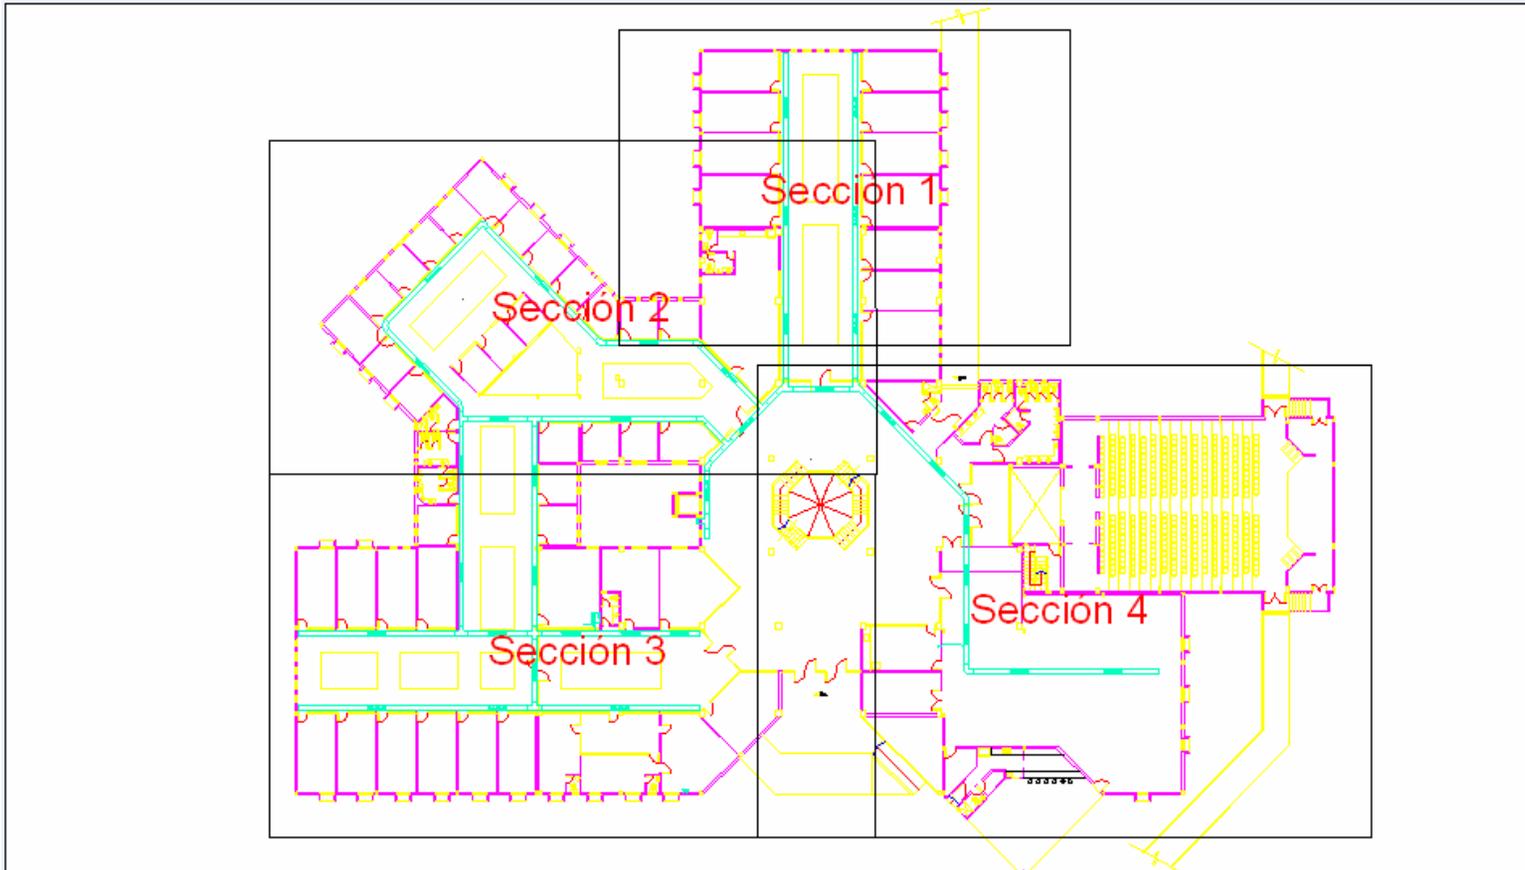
PLANO CLIMATIZACION PLANTA BAJA GENERAL
